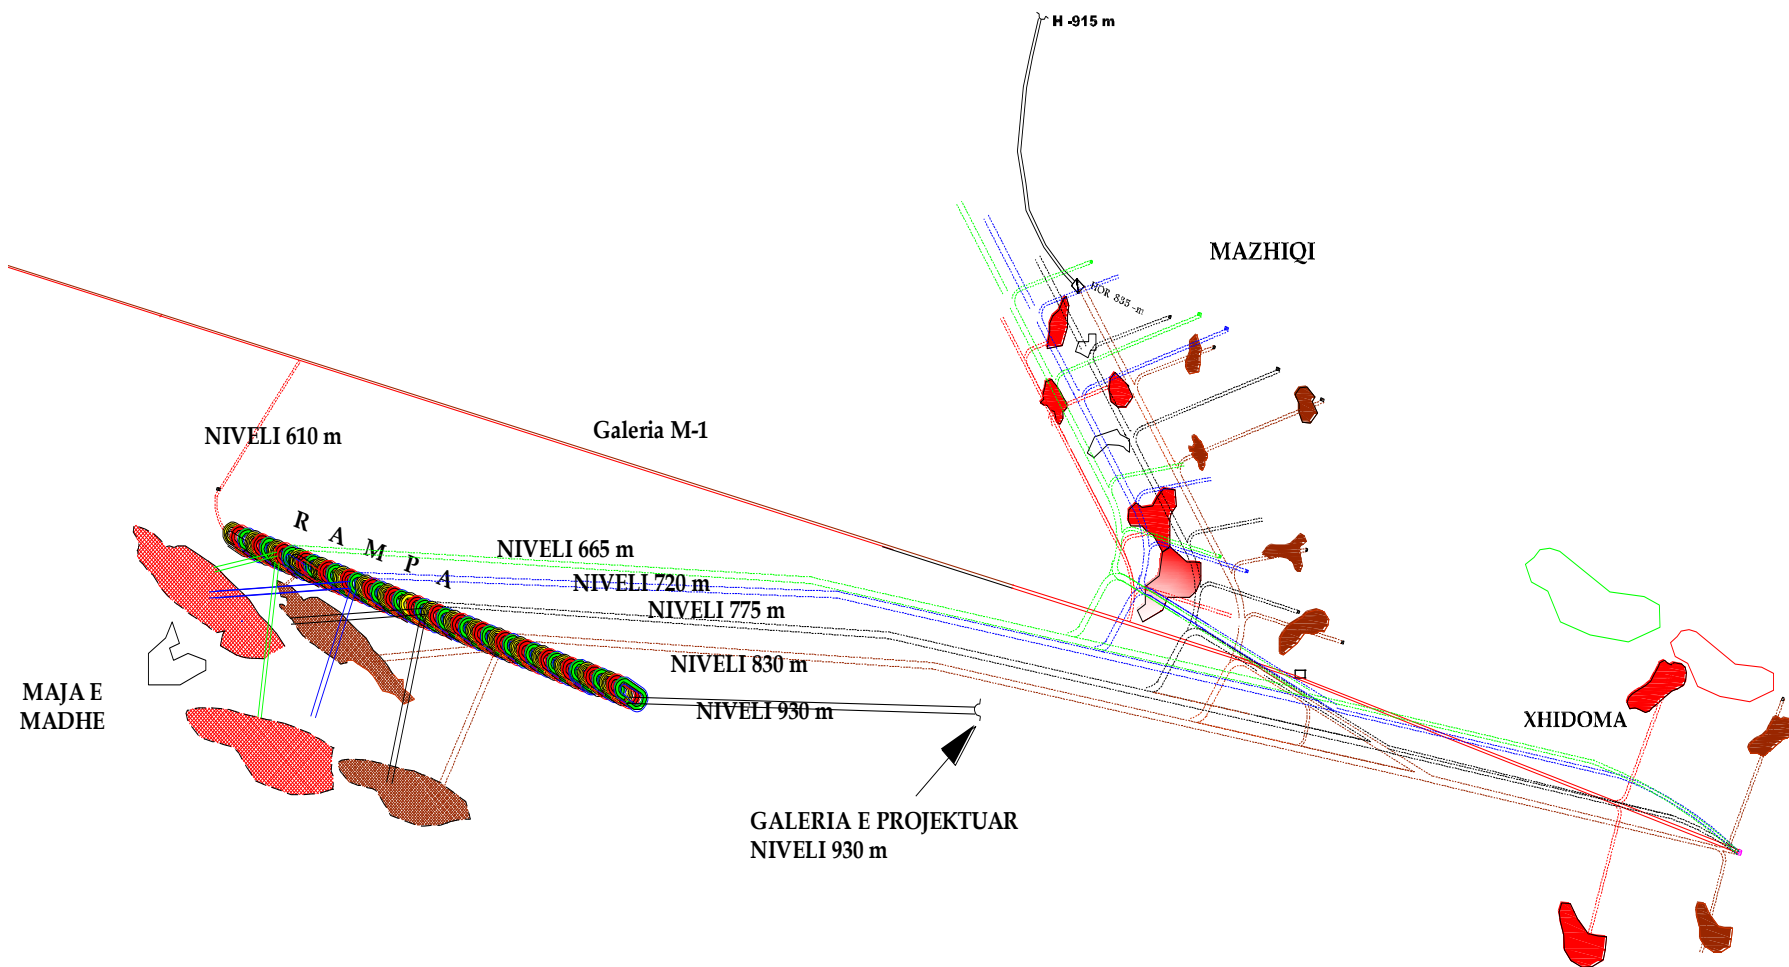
Paraqitja në plan e rampës dhe horizonteve
